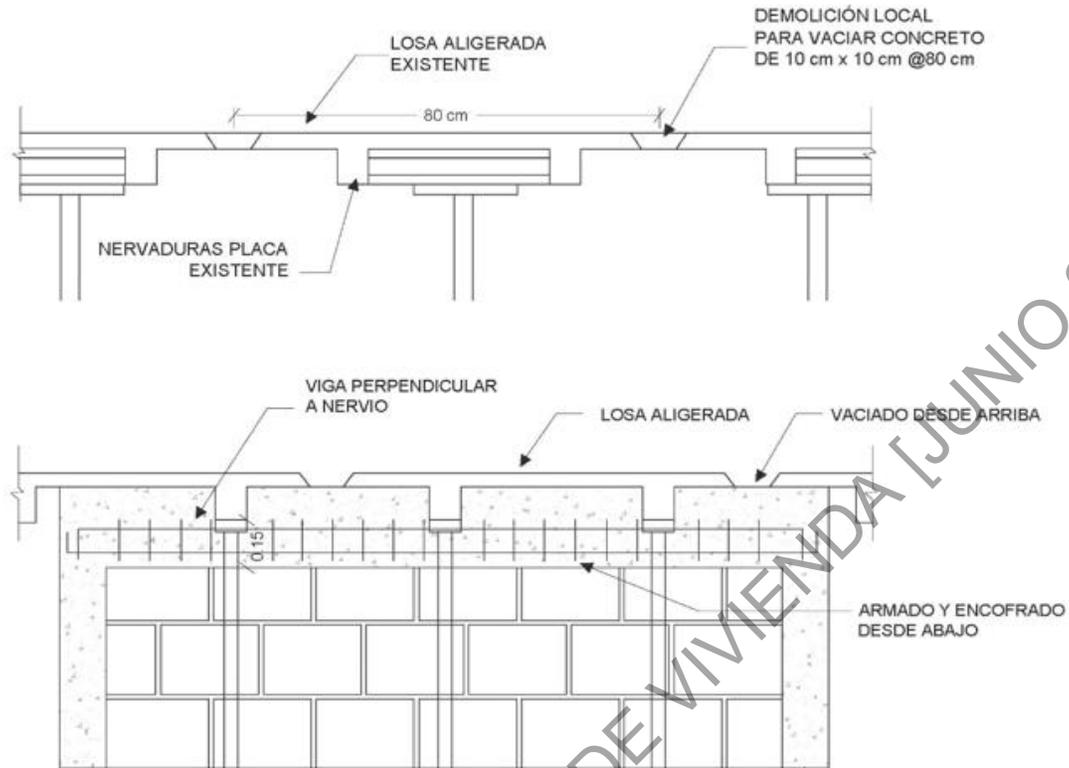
Conexión de muro nuevo a losa existente con nervios. Muro paralelo a los nervios.
